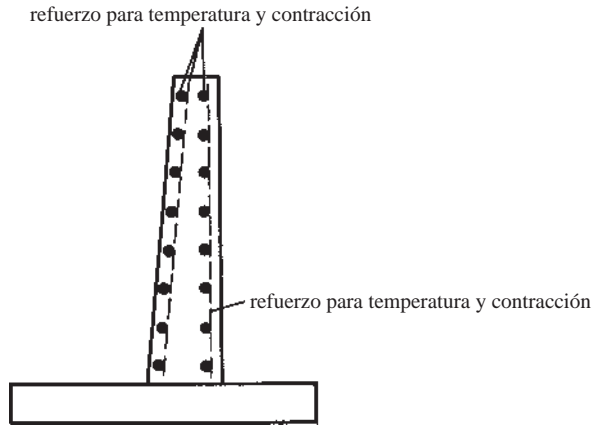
Muro de retención tipo voladizo con vástago ahusado.
